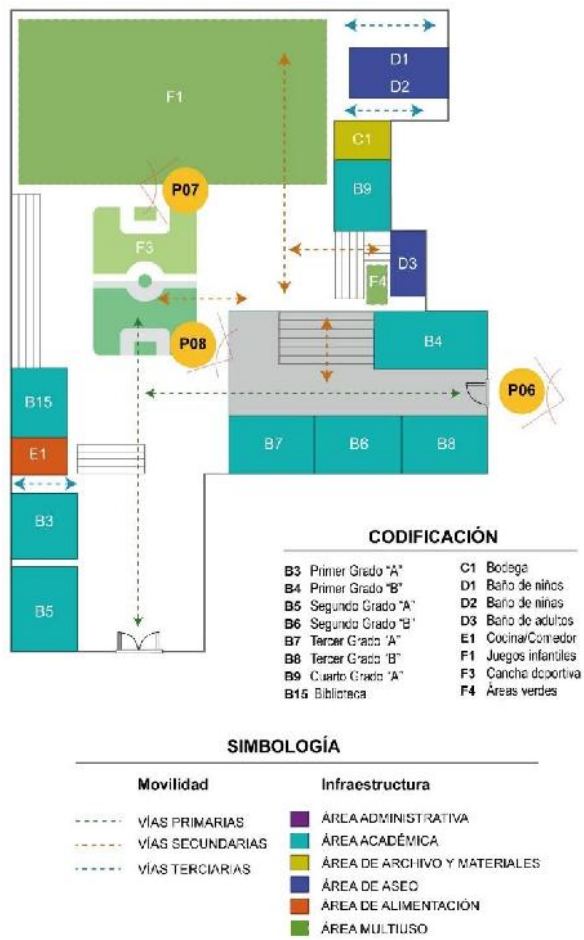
Plano y Puntos de vista - Bloque 2 – Planta Baja
